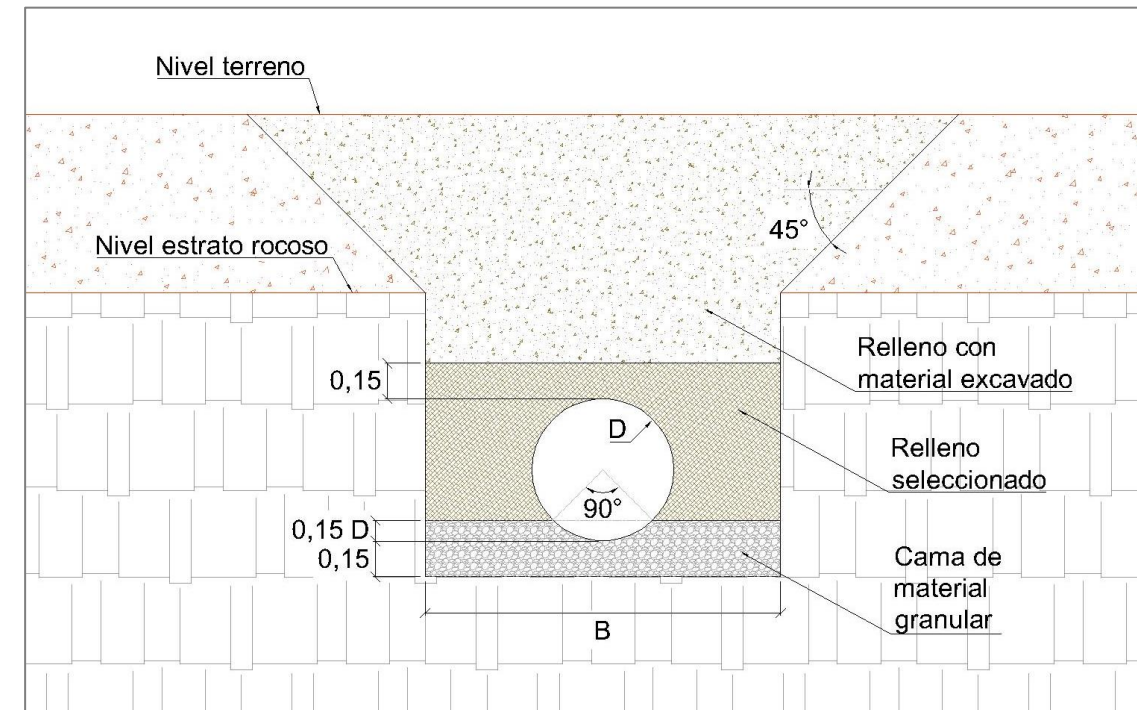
Sección transversal tipo en zona con estrato rocoso. Fuente: Elaboración propia
